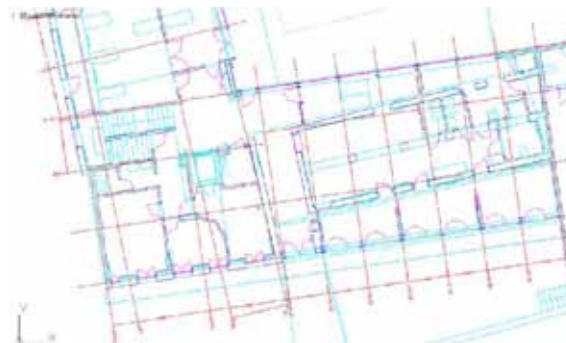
Desenho com estrutura de layers com a informação sobre elementos primários da construção para determinado piso
